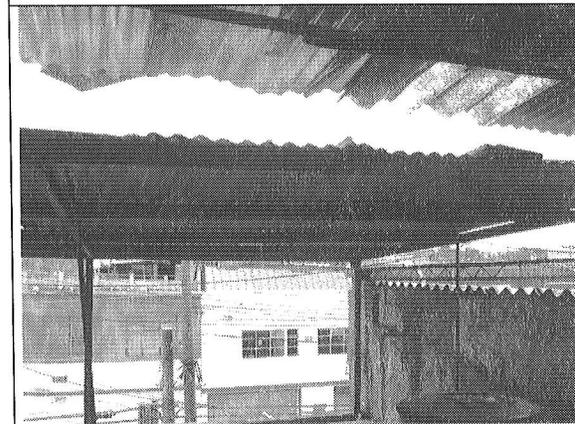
Grietas y deformación del cielo raso.
